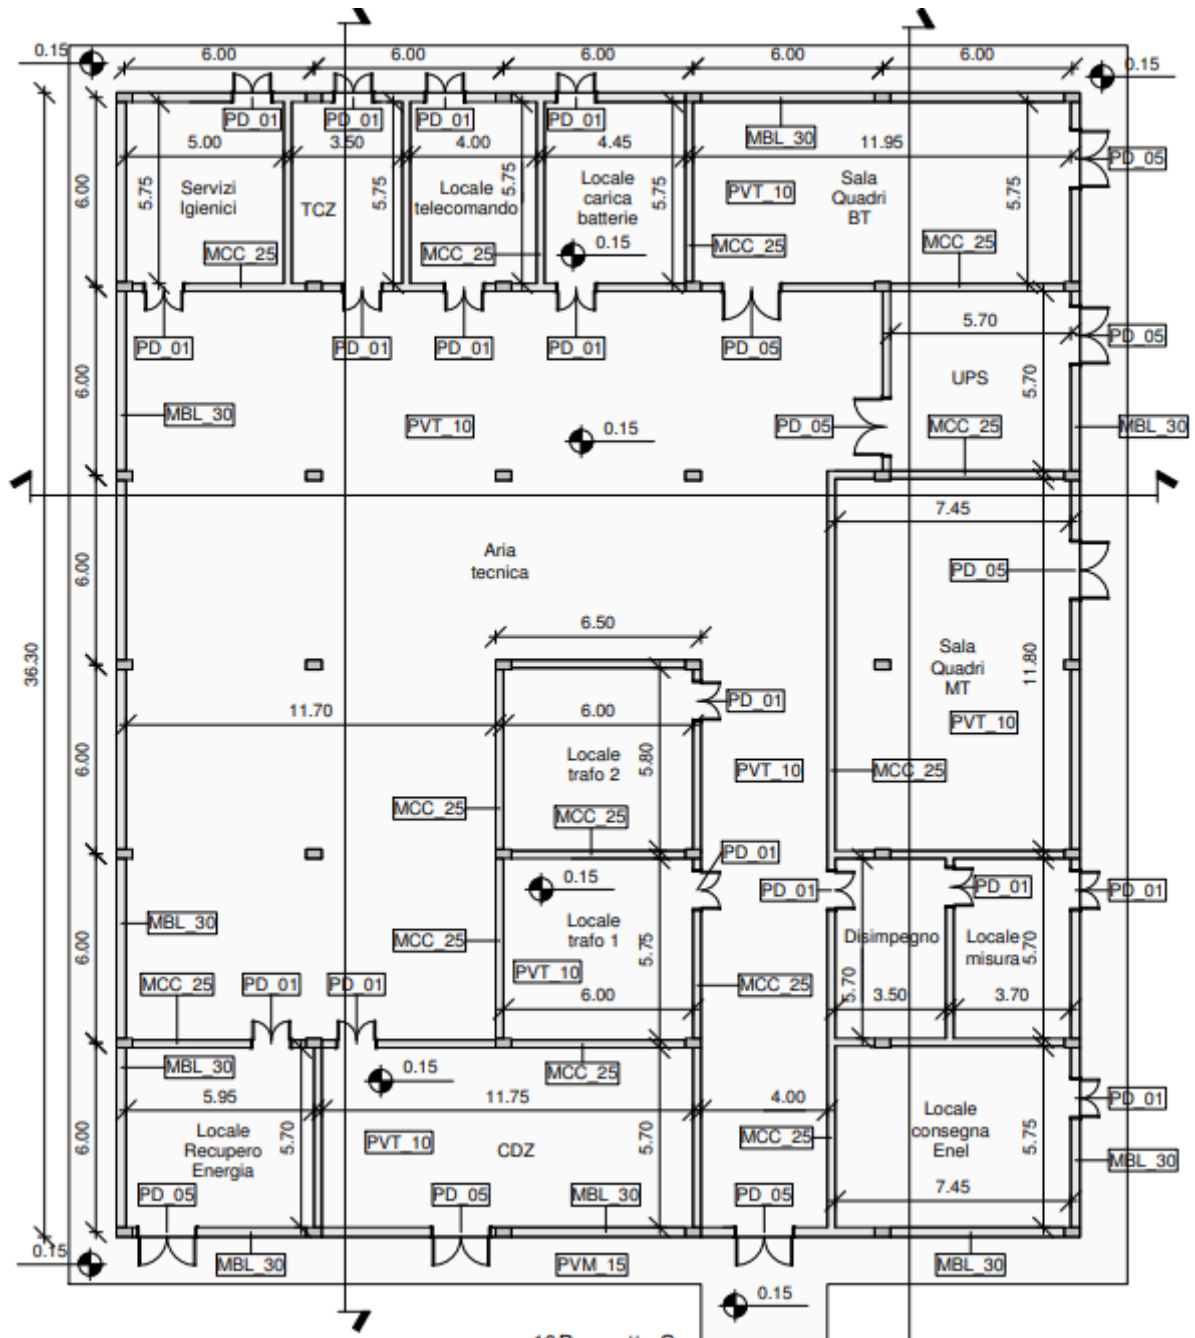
Pianta Manufatto Tipo D - Sottostazione Elettrica
